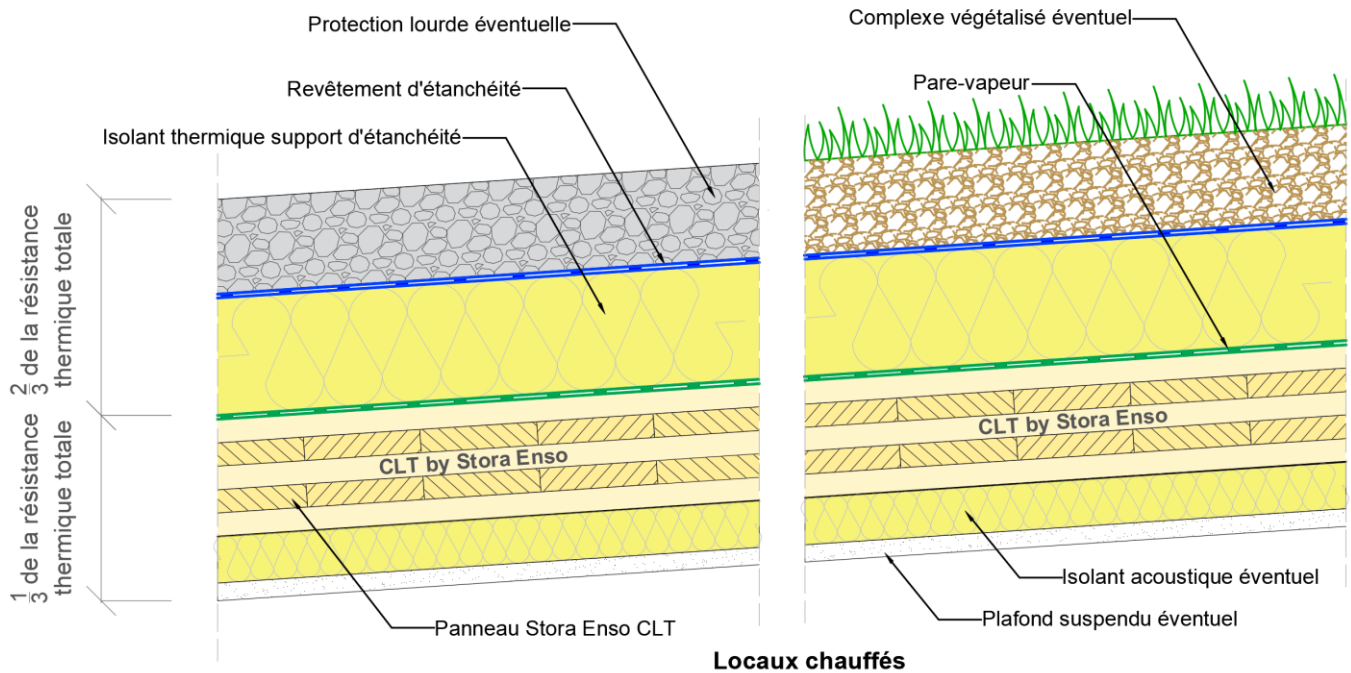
Schéma de principe - Toitures inaccessibles, techniques et végétalisées - Isolation support d'étanchéité.
